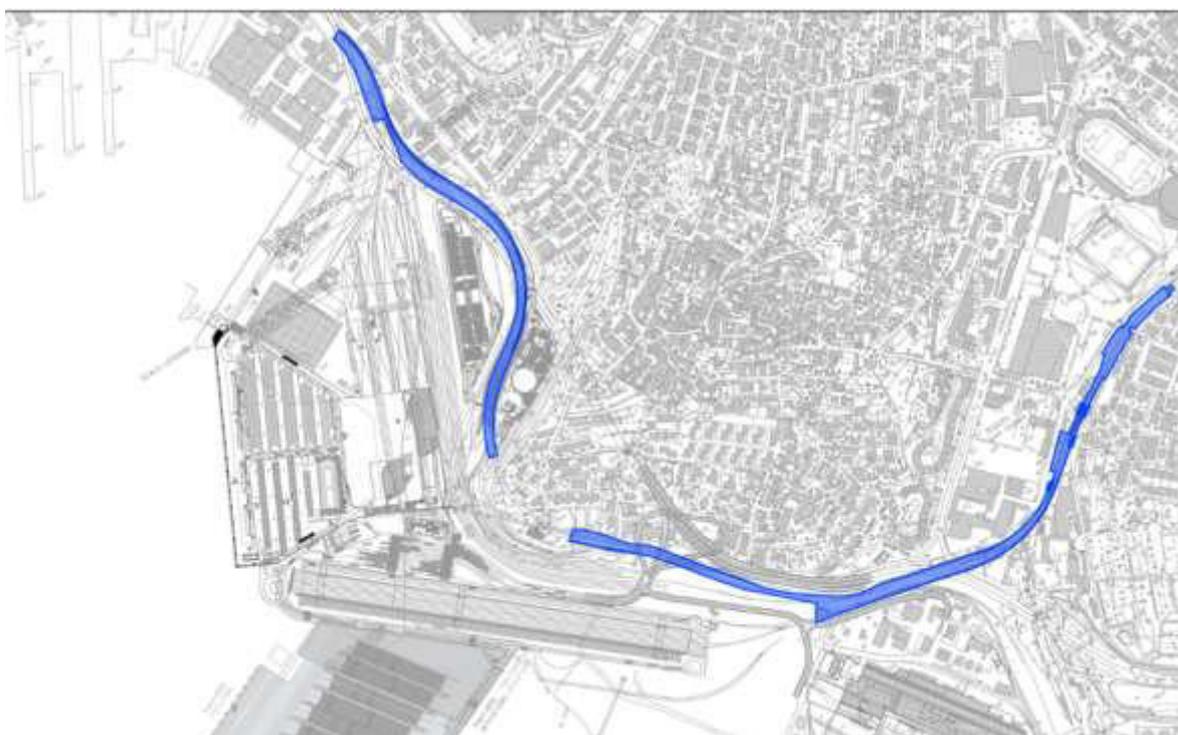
Planimetria delle opere ferroviarie Asset RFI
